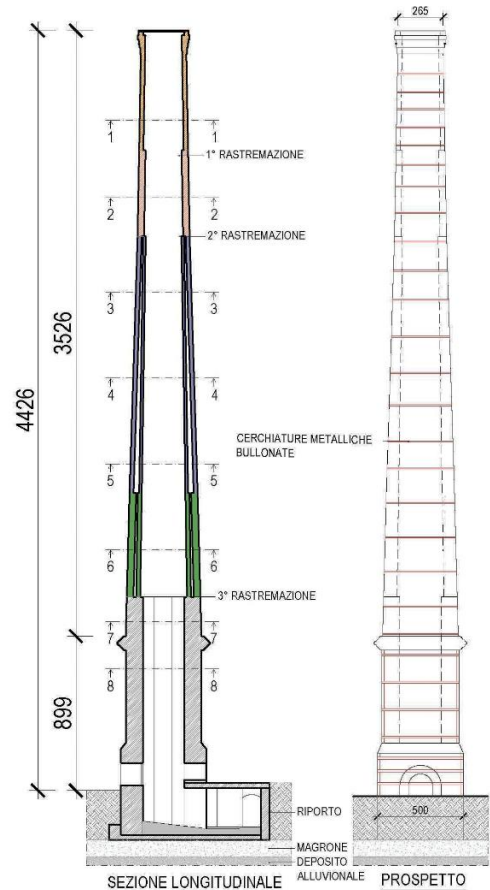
Sezione longitudinale e prospetto della ciminiera.
